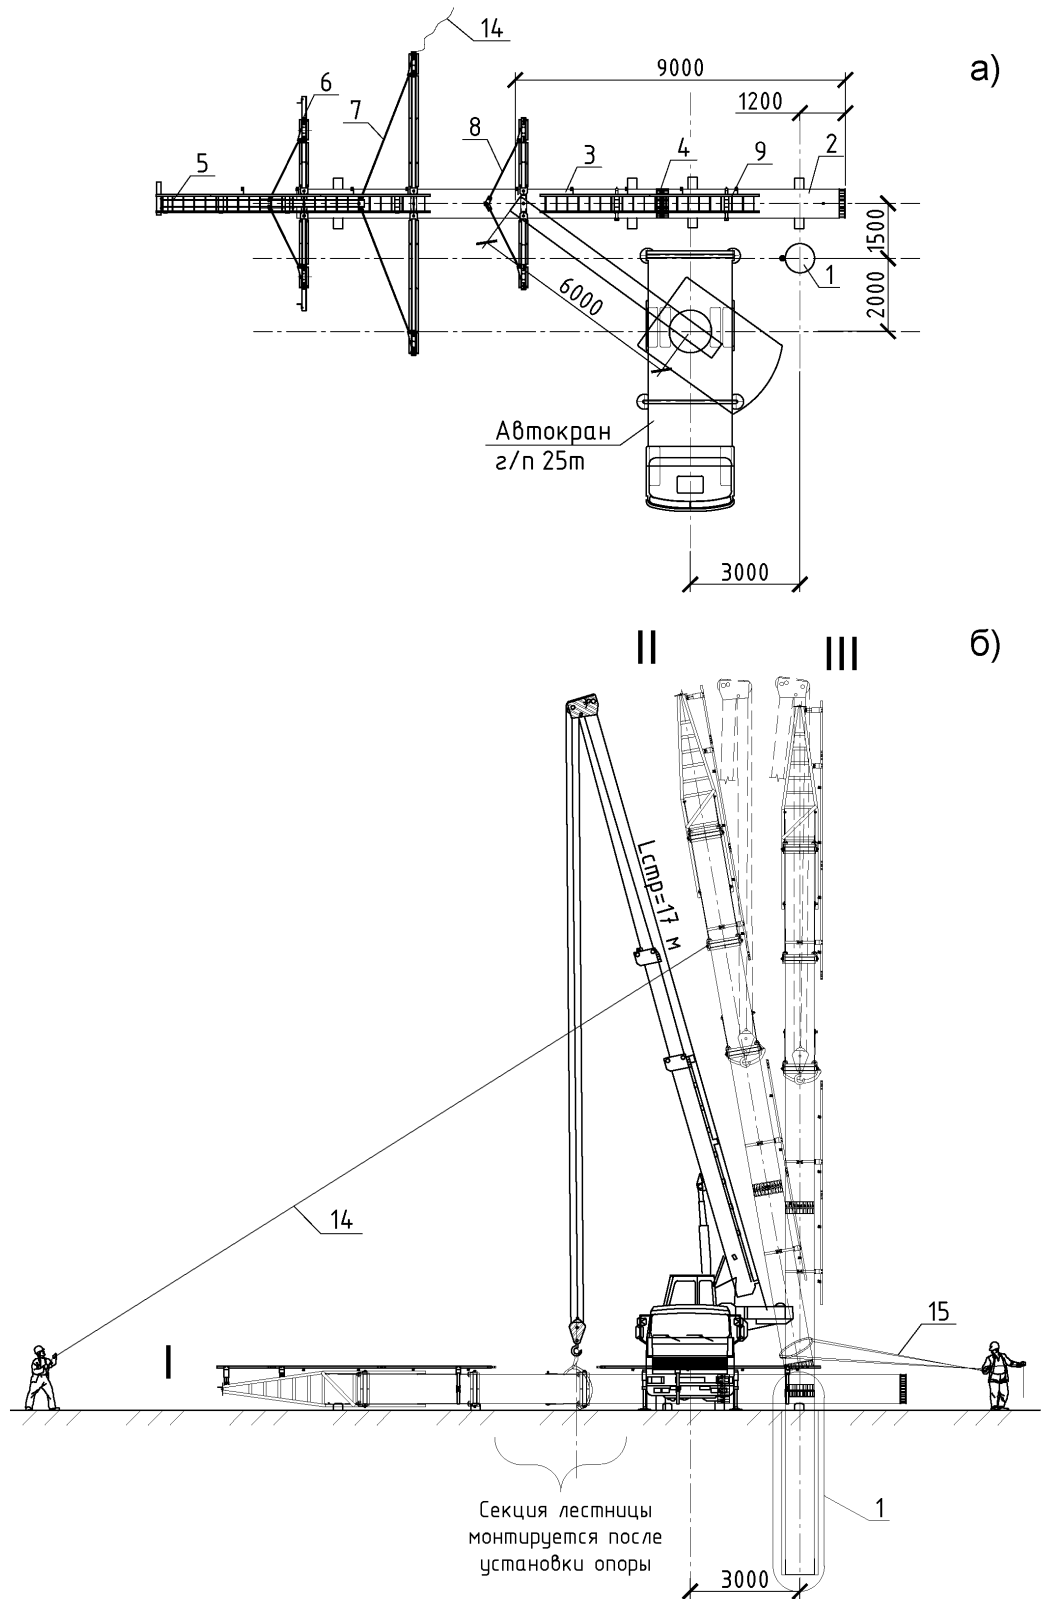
Схема сборки и монтажа опор СУБ110-2Ф и СУБ110-4Ф
